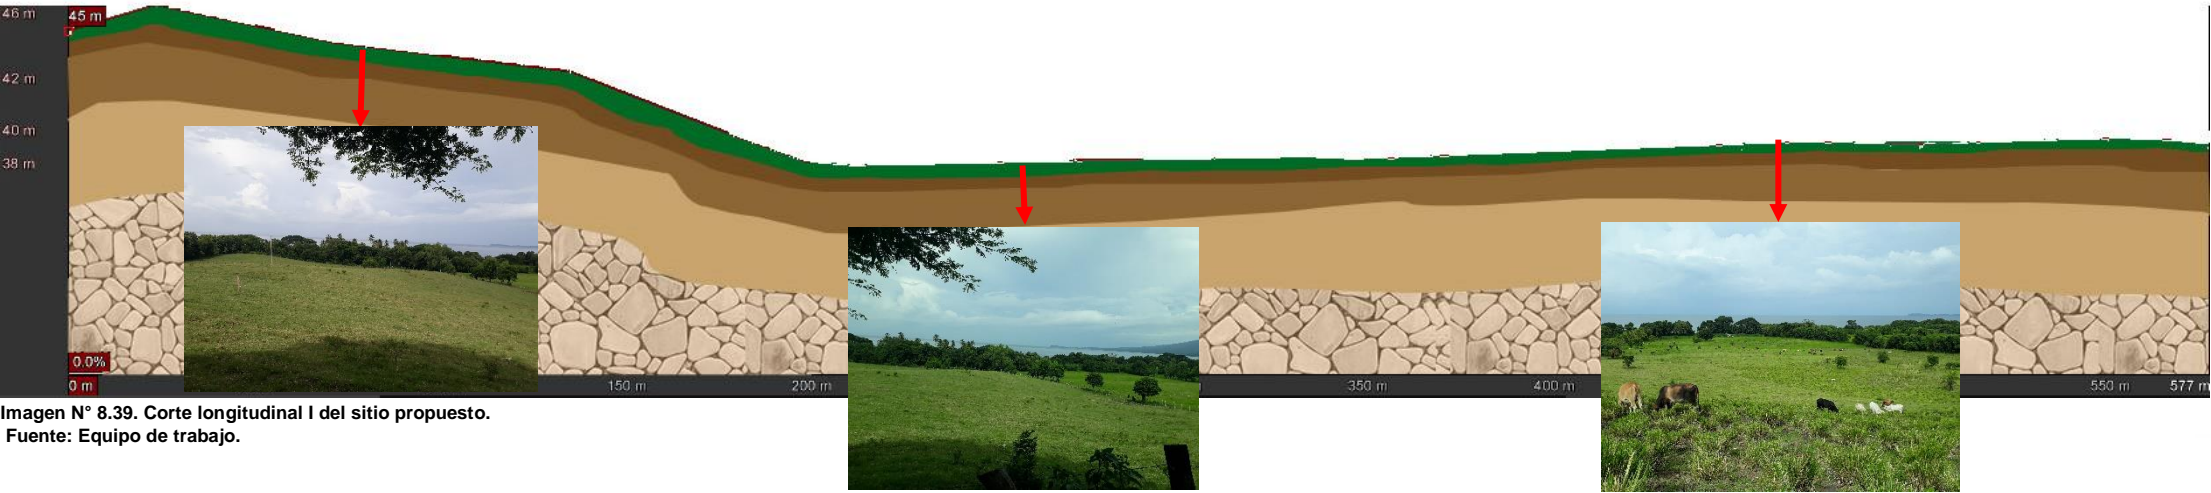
Corte longitudinal I del sitio propuesto.
